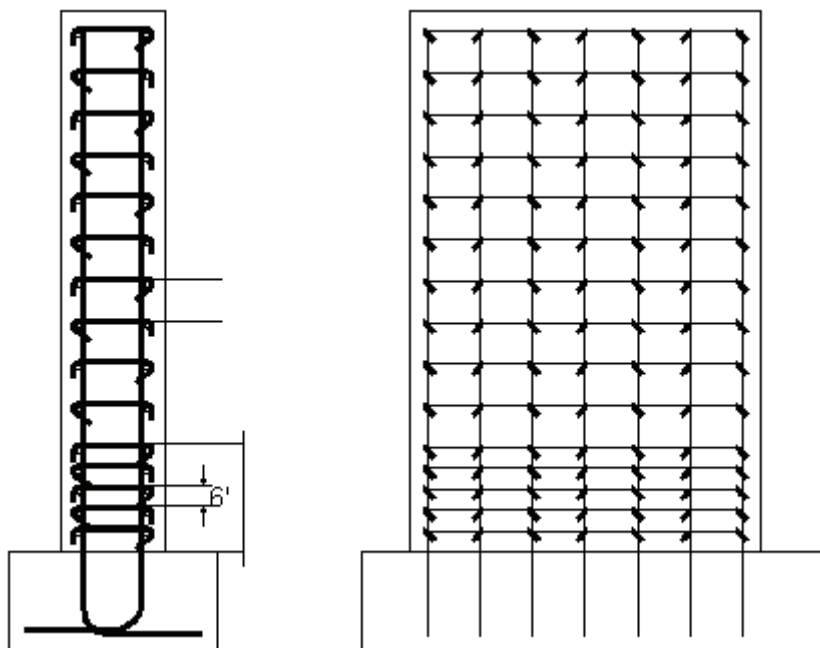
Refuerzo de confinamiento de un muro-pila lateral. Acero vertical sin empalmes, anclado a la fundación, arriostrado horizontalmente con ganchos. (Fuente: Caltrans, 1999)
